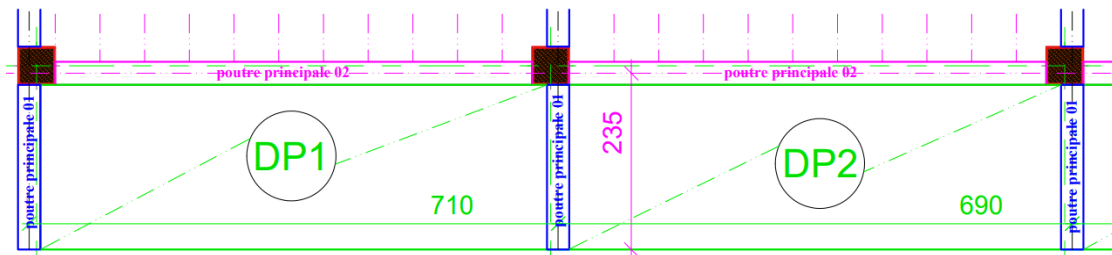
dalle pleine sur trois appuis DP1 et DP2
